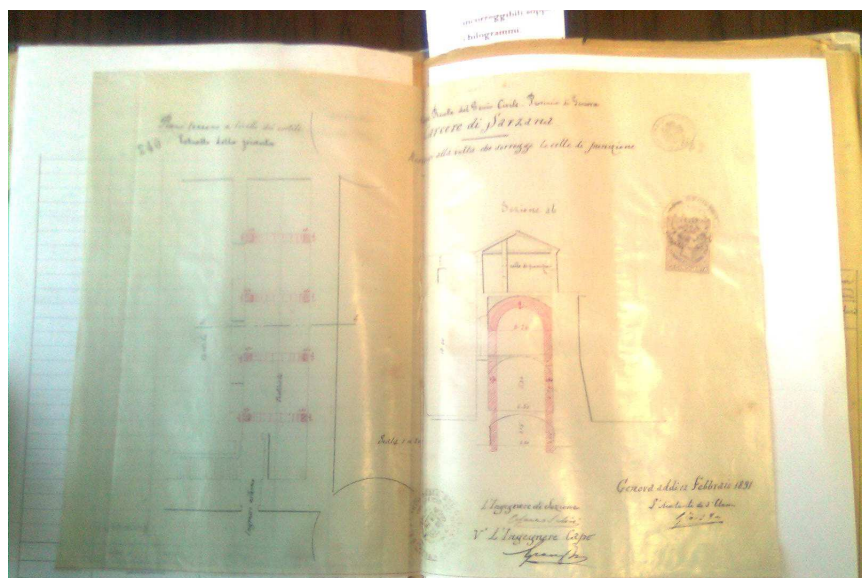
pianta e sezione del progetto di rinforzo volte 2° piano corpo nord del 2° cortile
